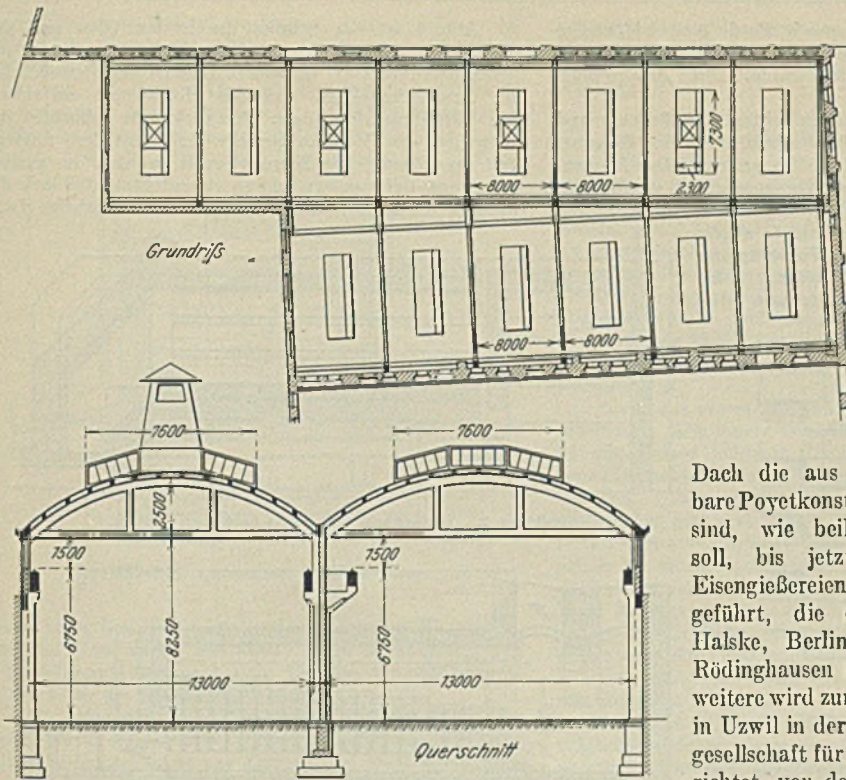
Gießerei in Eisenbeton mit Dach in Poyetkonstruktion.
